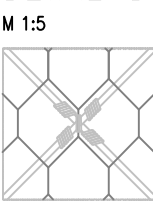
DETAIL–SPÁJENÍ LANOVÝCH PANELŮ
